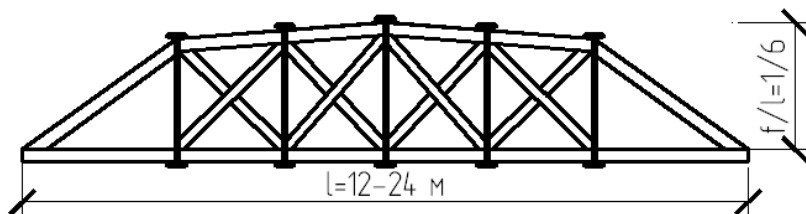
Пятиугольная ферма из брусьев или бревен на лобовых врубках.
